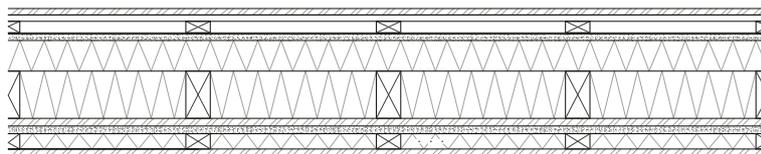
Fassadenschnitt mit Ansichtstreifen. M 1:100
